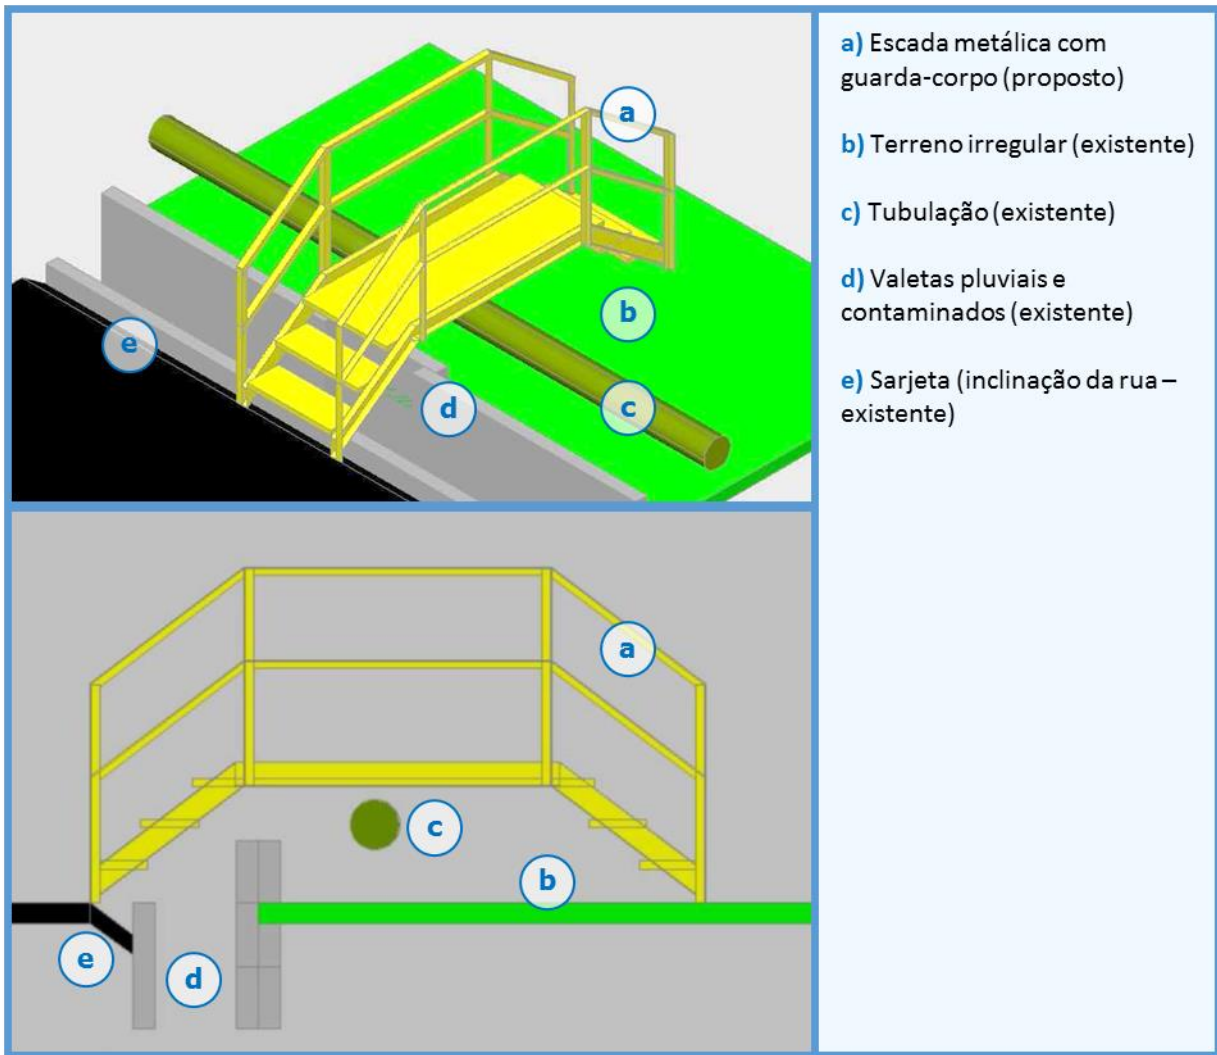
Vista em perspectiva do CAD 3D de projeto conceitual inicial de guarda-corpos
